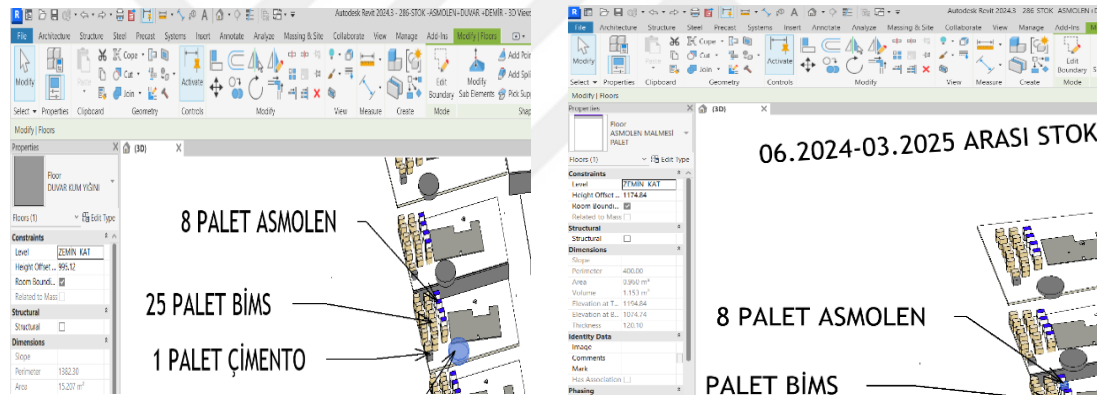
06.2024-03.2025 Stok Planı Revit Modeli 3D Görünümü
